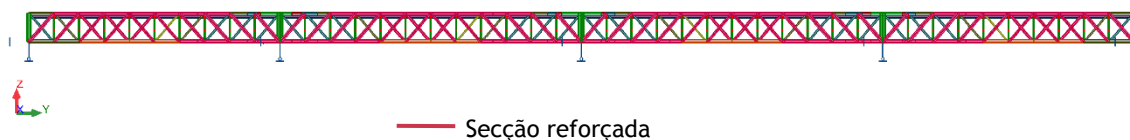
Reforço dos elementos estruturais na estrutura metálica
